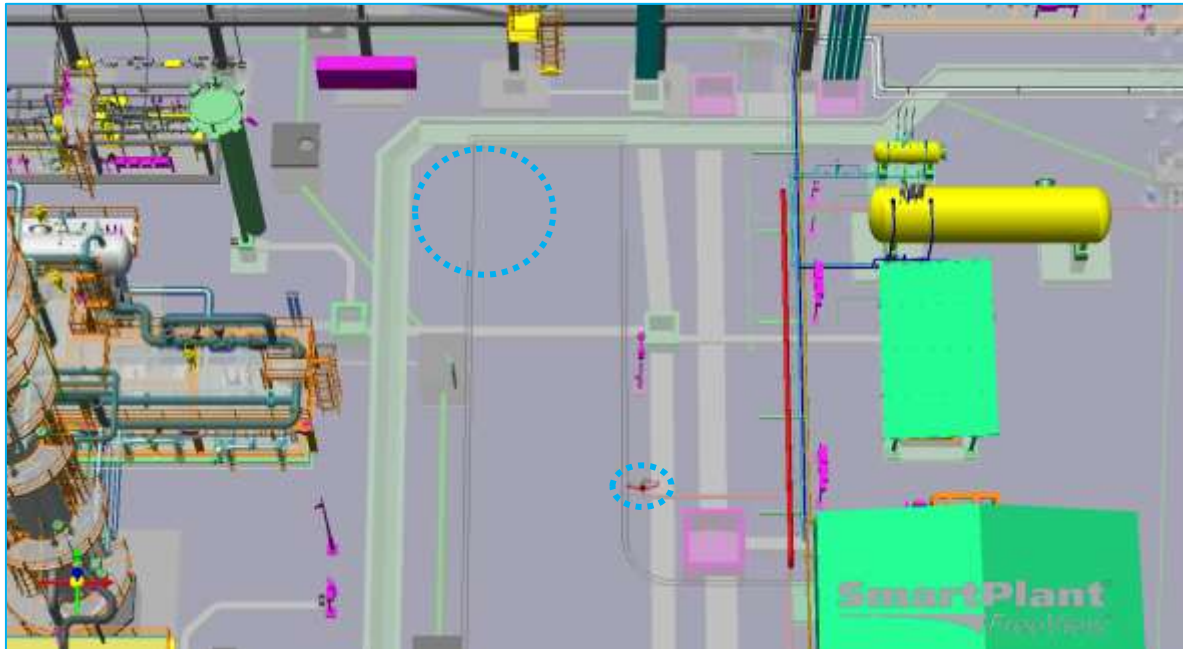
Ubicación del canal de drenaje pluvial – Maqueta 3D - PSLRG
